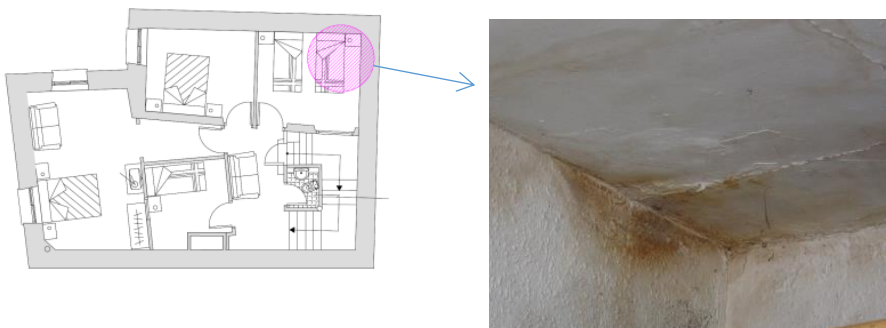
Humedades en una habitación en planta primera. 2017. Fuente: Autor.
